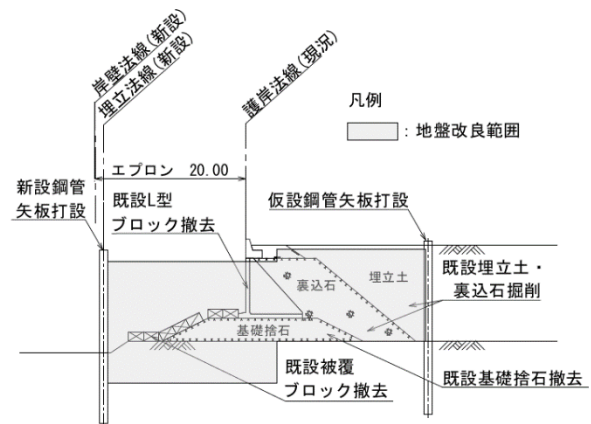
荷役部側岸壁の施工断面図(図4A-A'断面)
